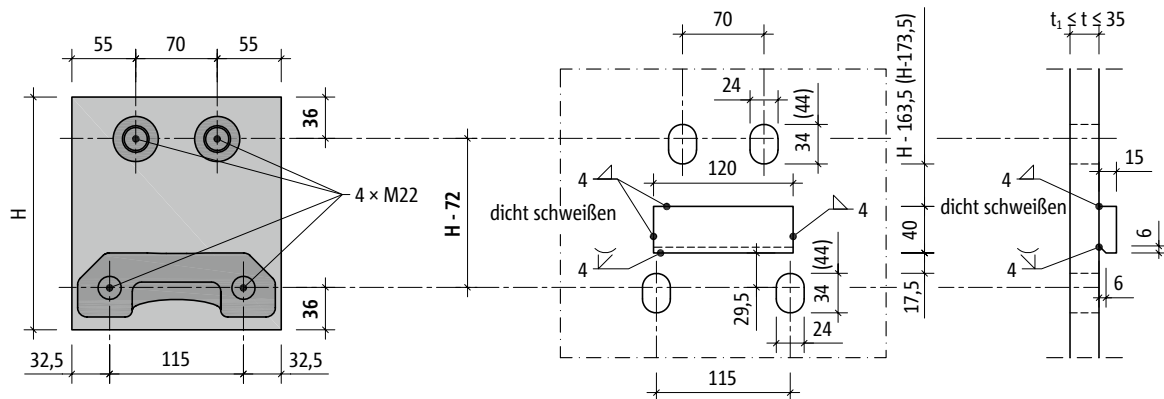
Schöck Isokorb® T Typ SKP-MM2 mit CV26: Konstruktion des Stirnplattenanschlusses mit Betondeckung CV26 (ersetzt durch T Typ SKP-MM2-...-CV28)
